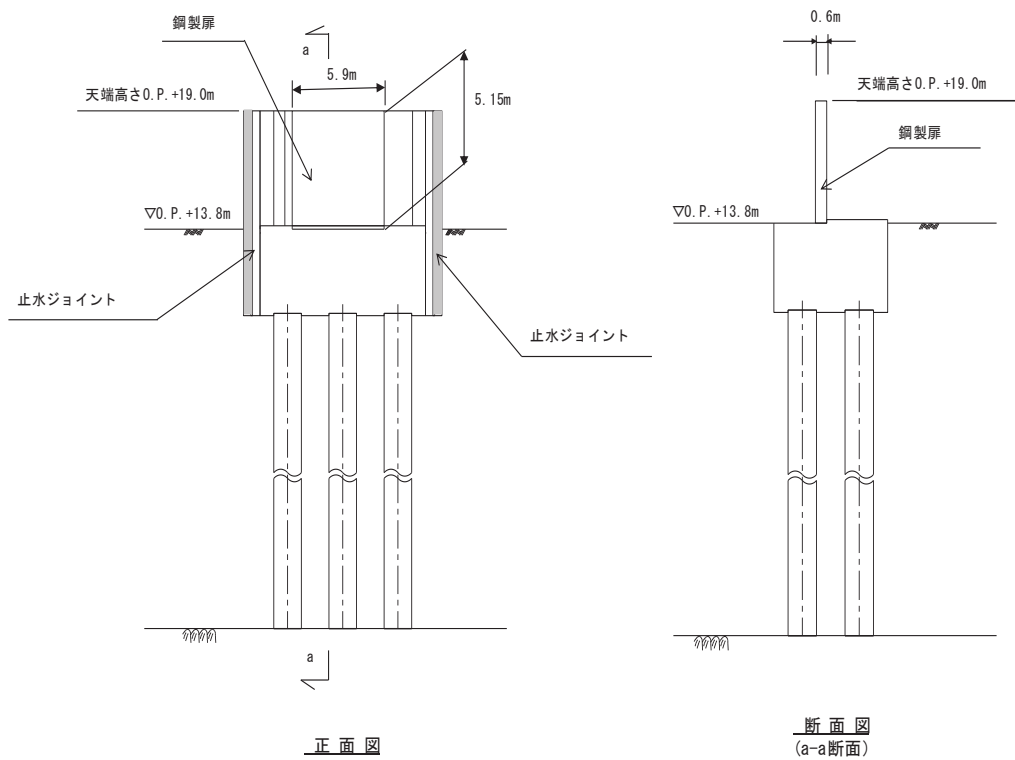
10. 4-29 鋼製扉 4 正面図及び断面図
